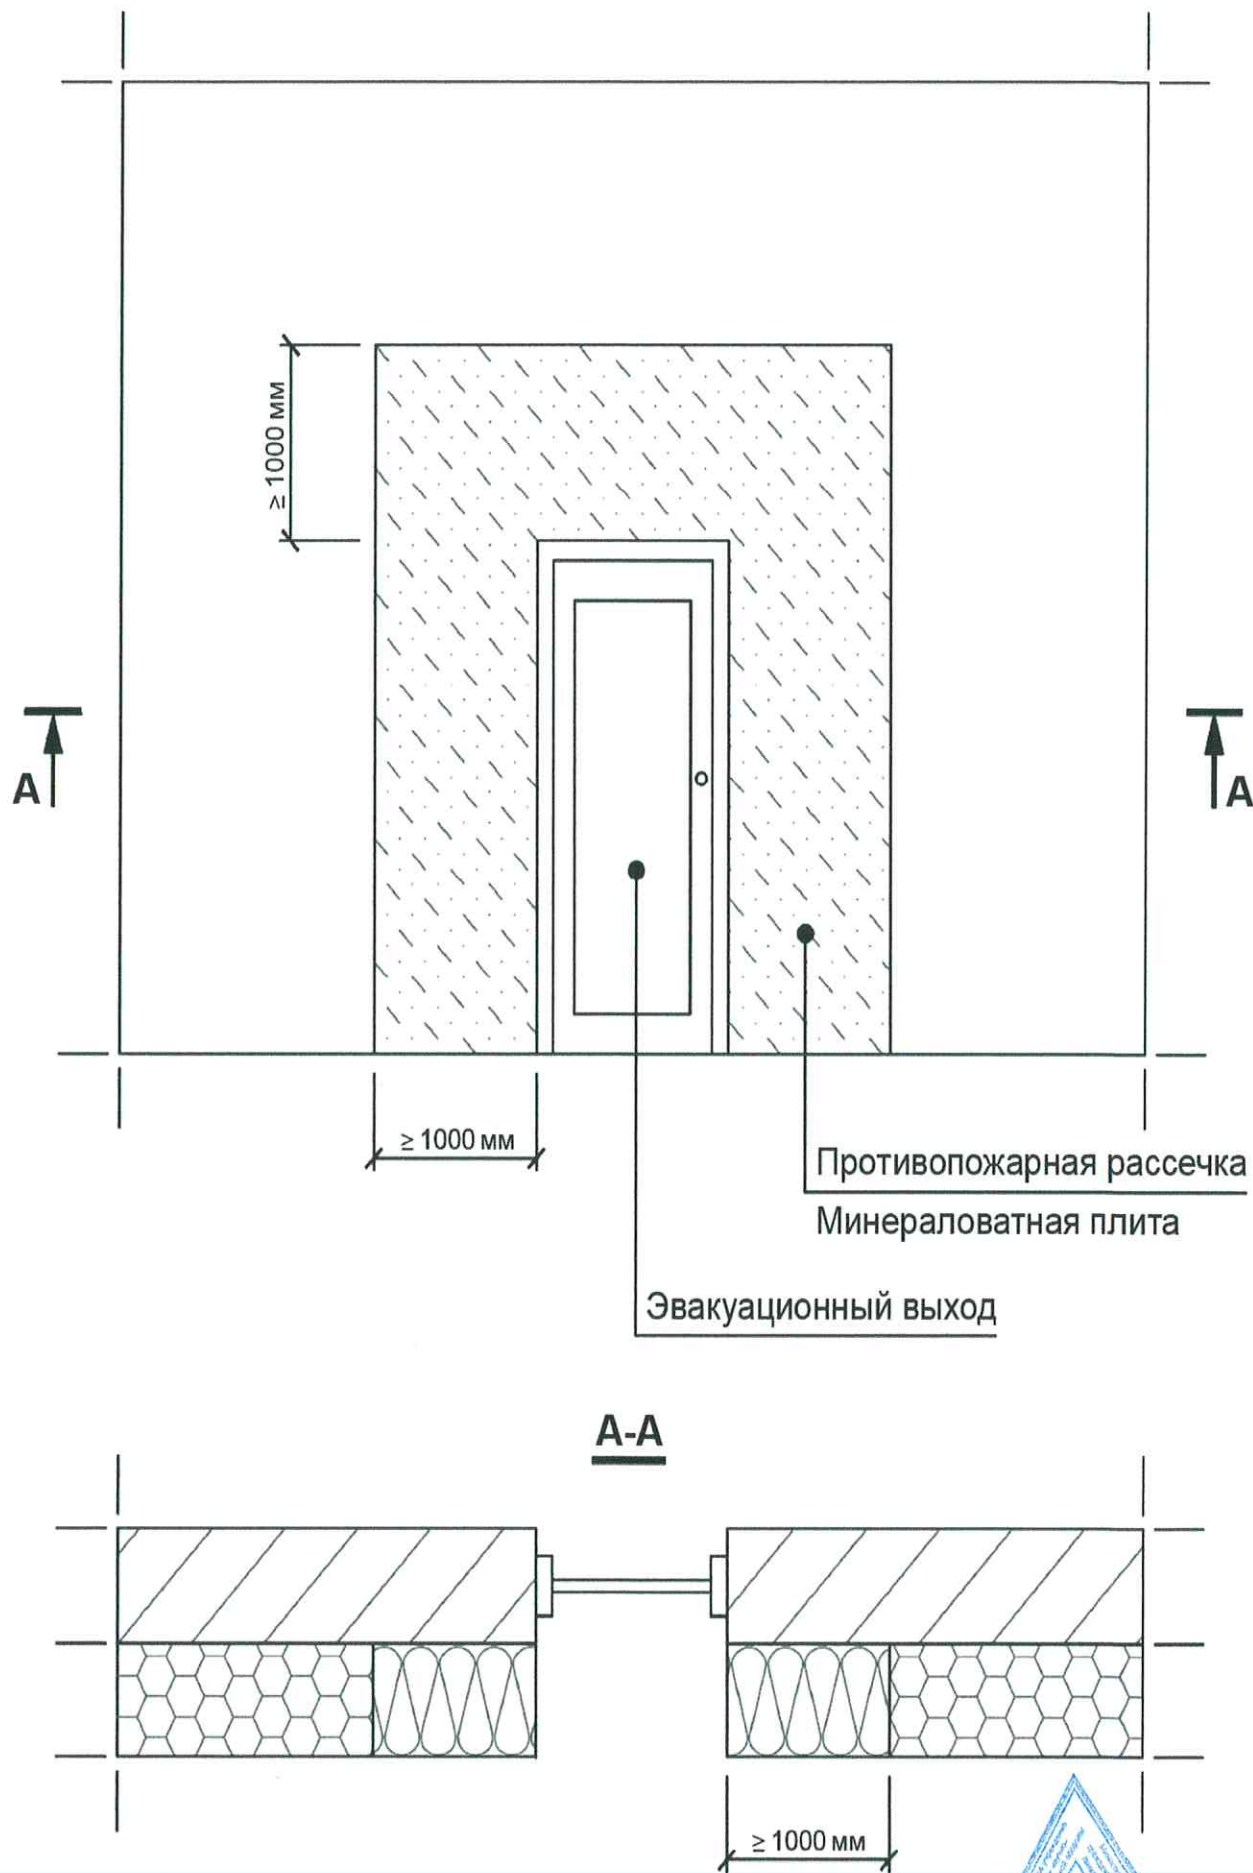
Участки наружных стен по периметру эвакуационных выходов из здания
